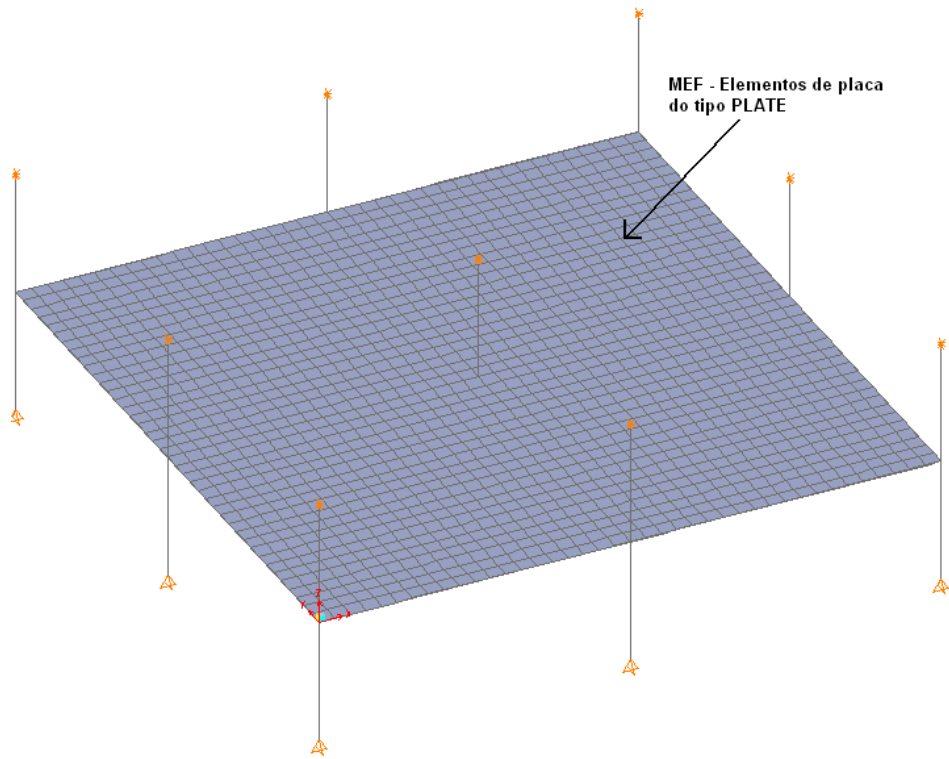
Laje modelada com elementos de placa do tipo PLATE THIN - MEF
